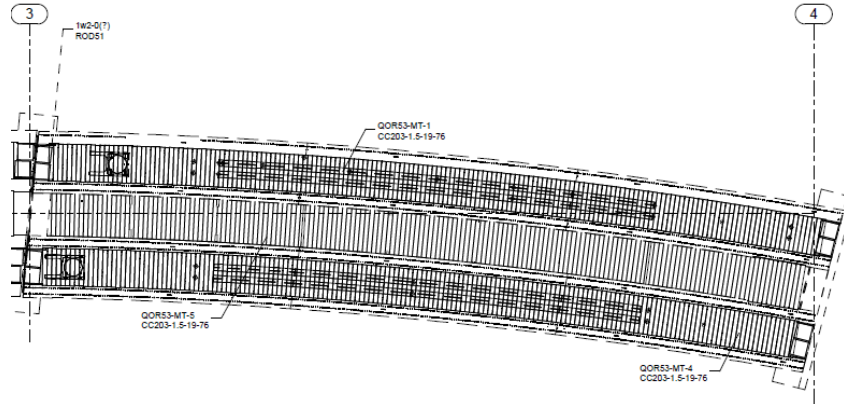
Planta del claro 3-4 de los montenes sobre las trabes metálicas
